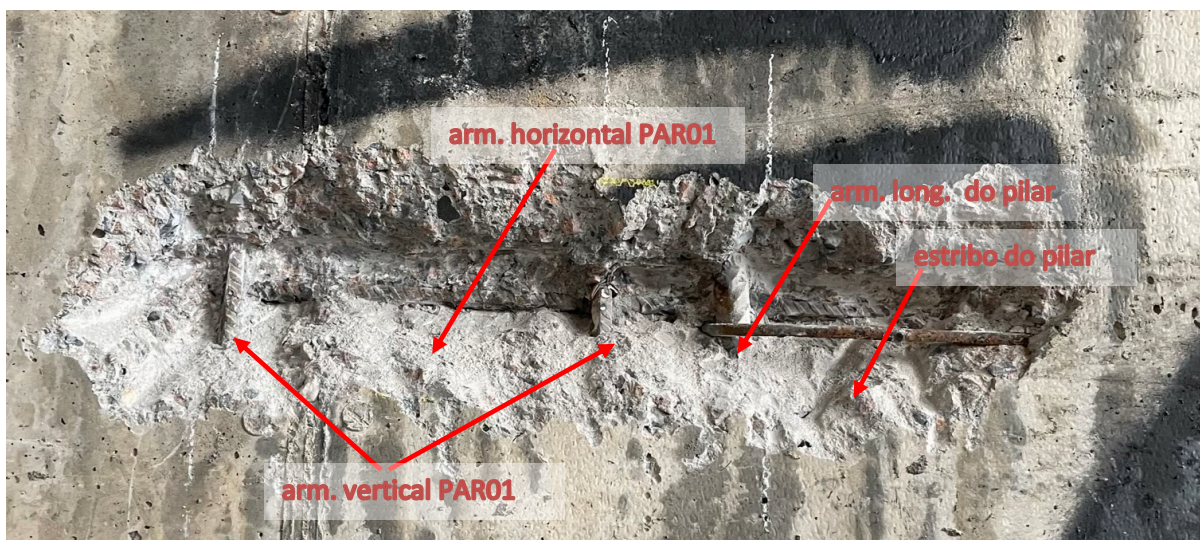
Detalhe das armaduras na incisão no lado interno da parede PAR01.
